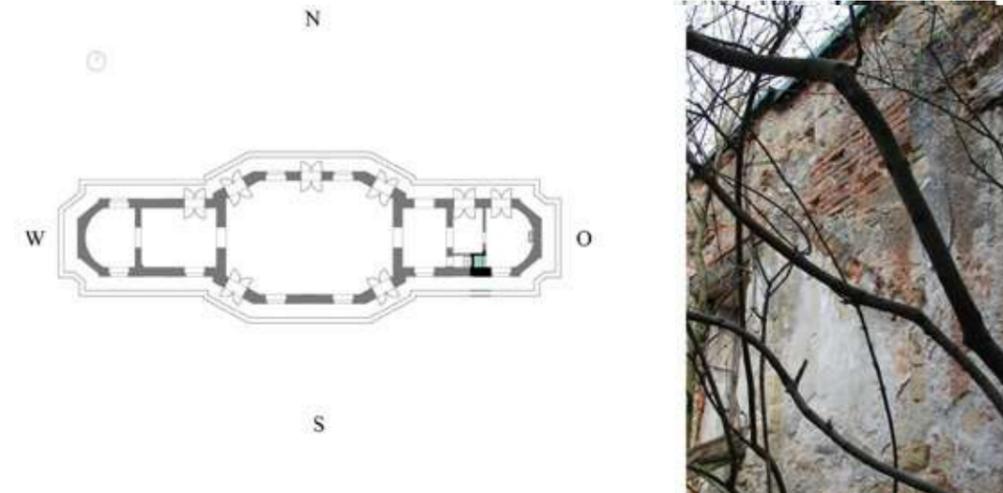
Lage im Grundriss, Großaufnahme der existierenden Südwand
